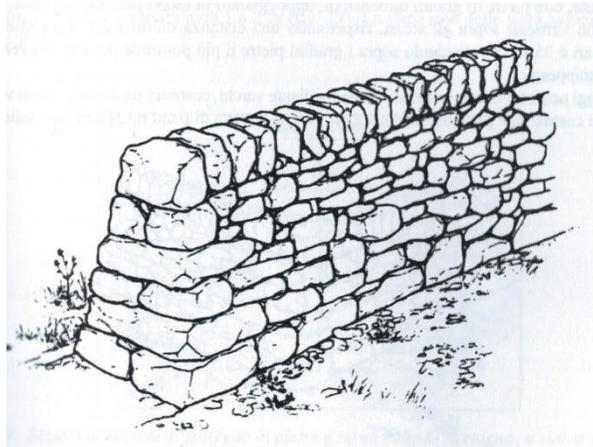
Muretto a parete semplice (Di Fidio, 2007; SUS, 2001)
